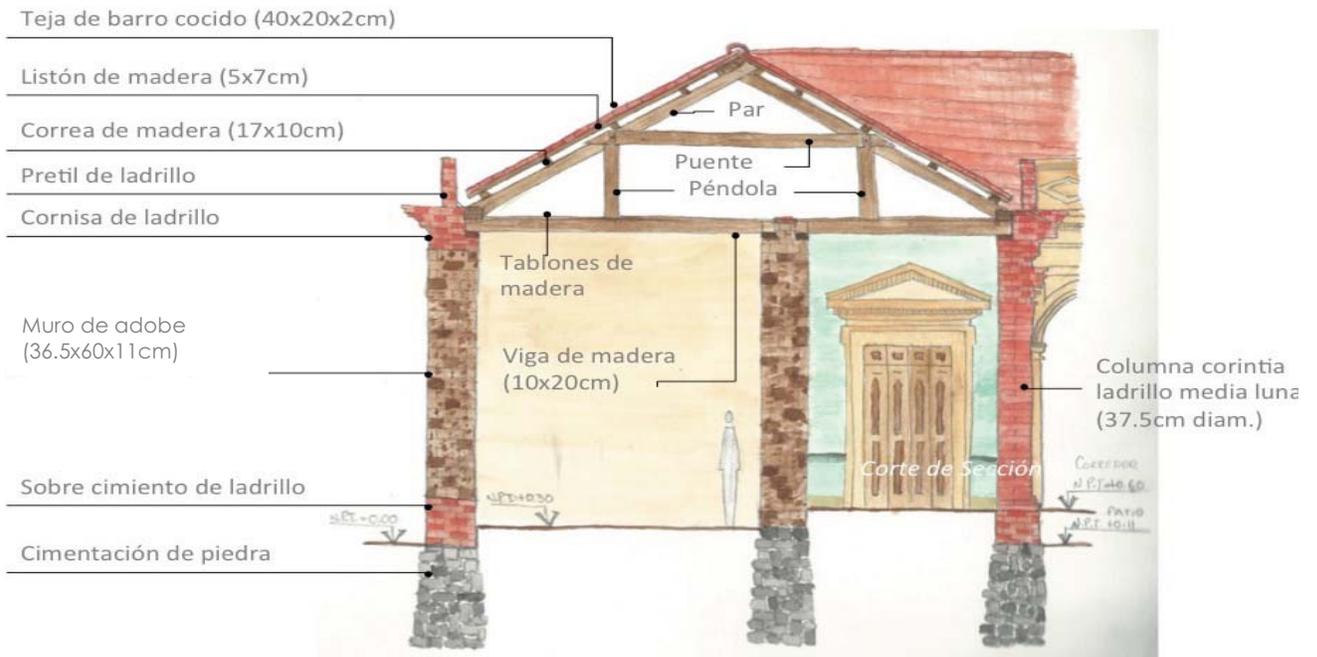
CORTE POR FACHADA. SECCIÓN A DE LA CASA “LA ENSEÑANZA”.
